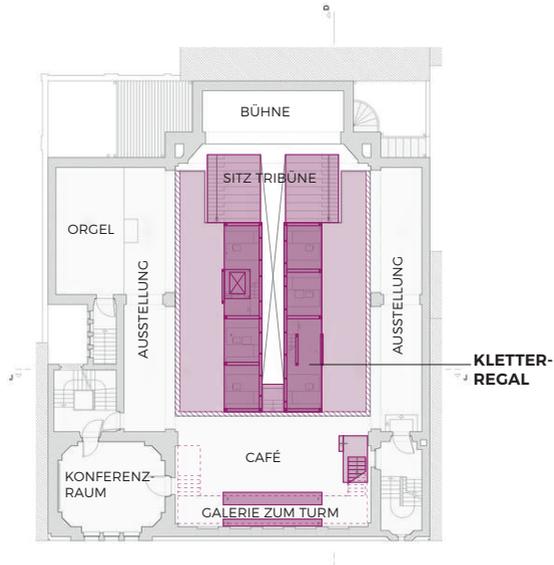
Grundriss Gesamt OG 1:500
